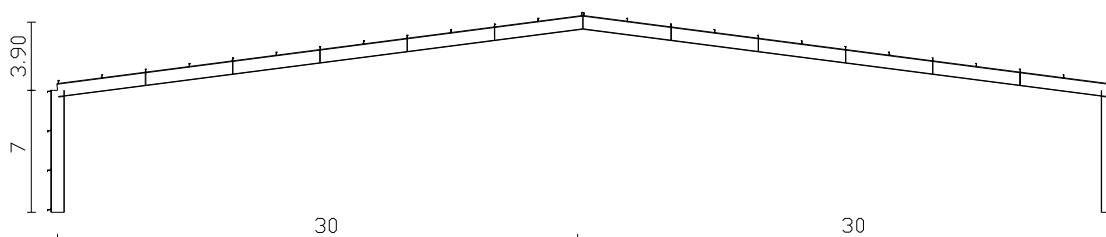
Pórtico rígido viga e pilar de alma cheia, vão de 60.00m
